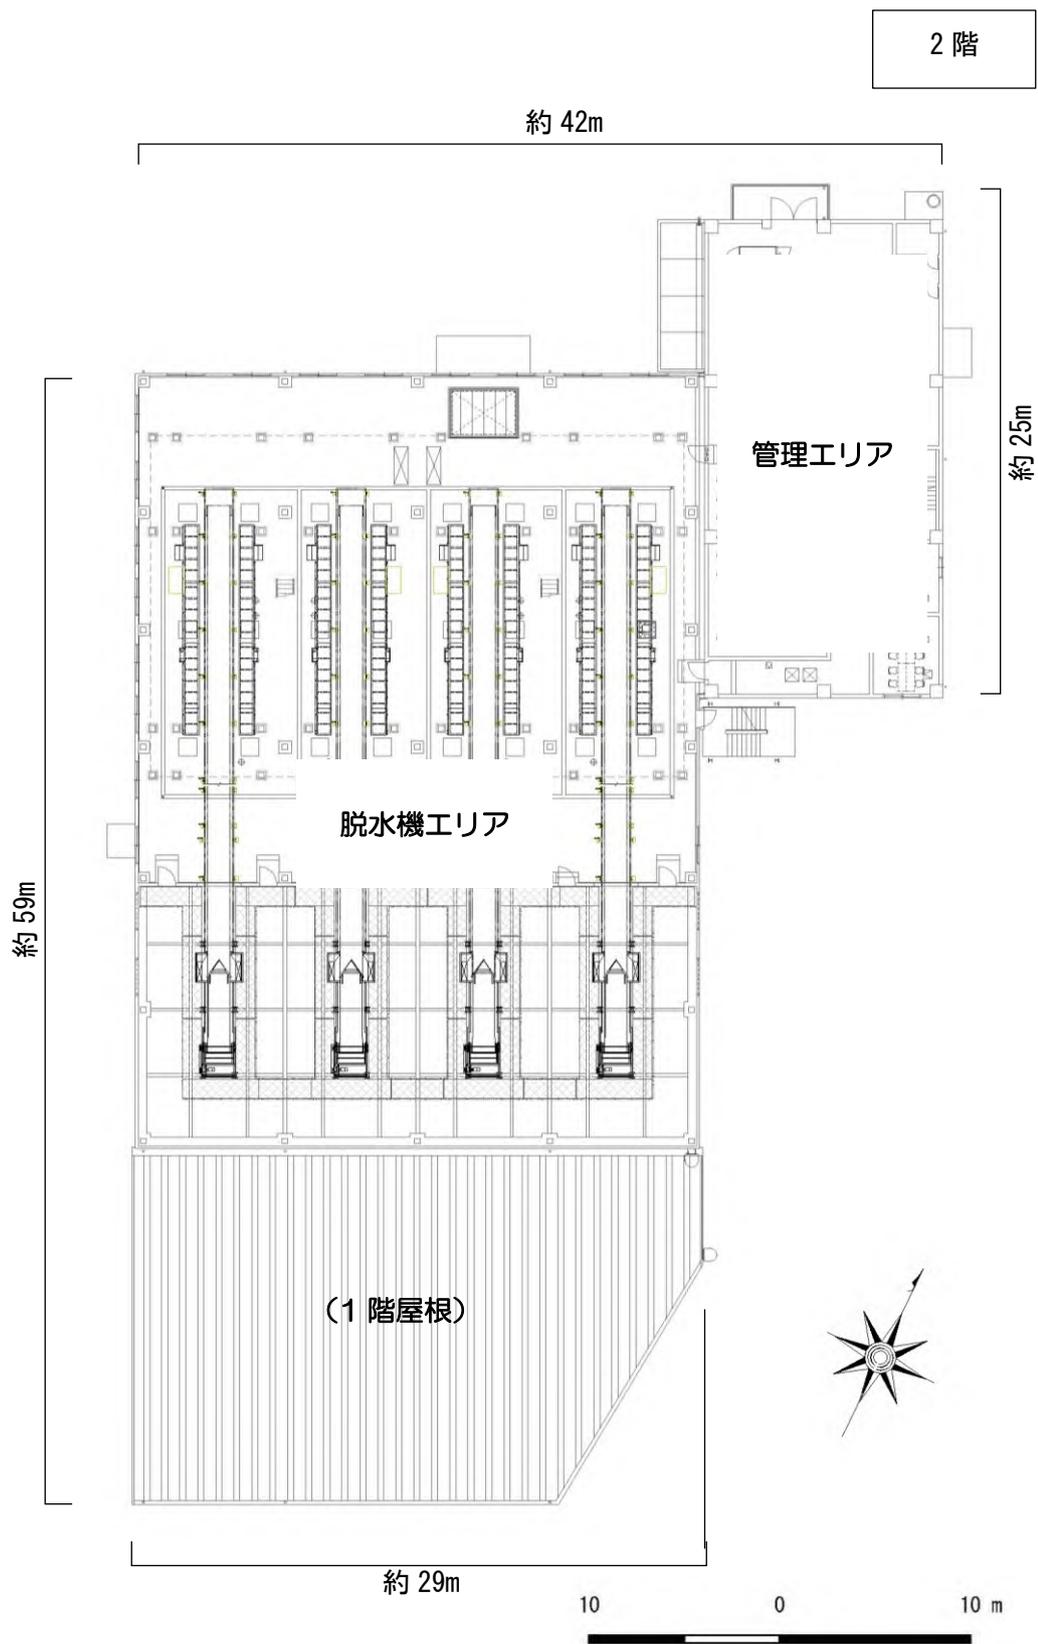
(2) 2階平面図 (縮尺 1:400)
